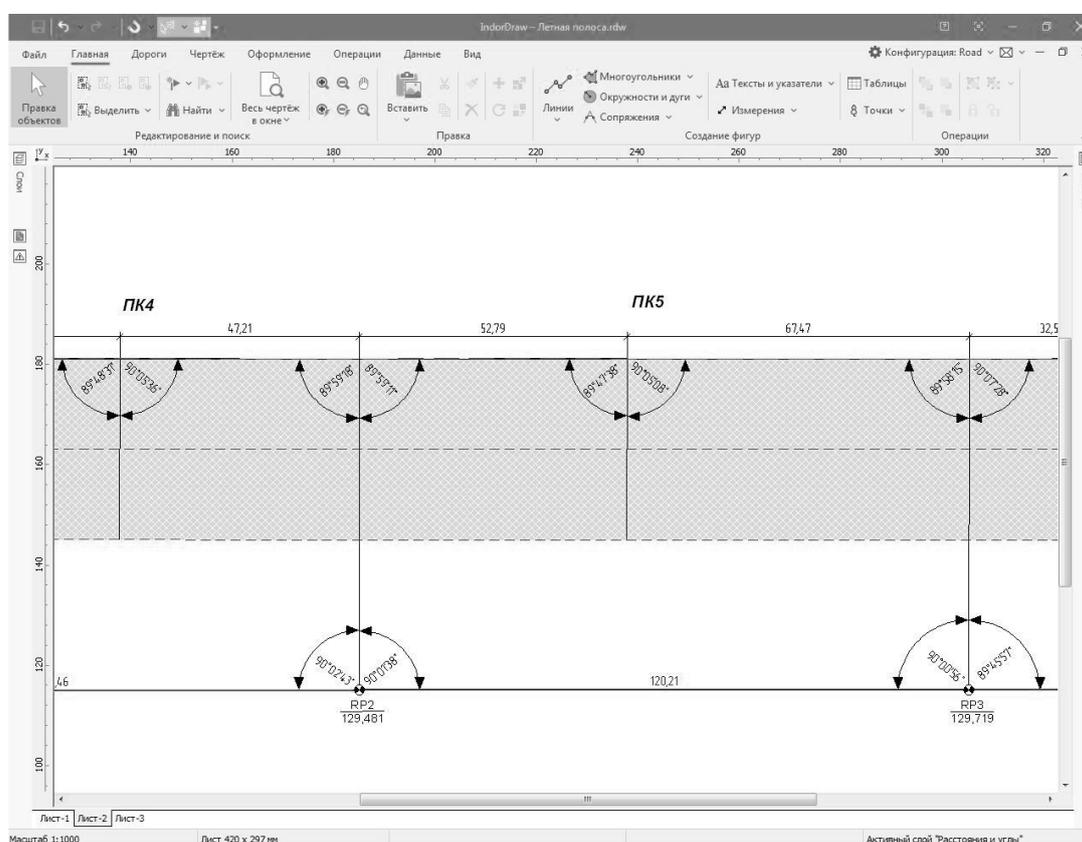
Подготовка разбивочного чертежа в системе IndorDraw
